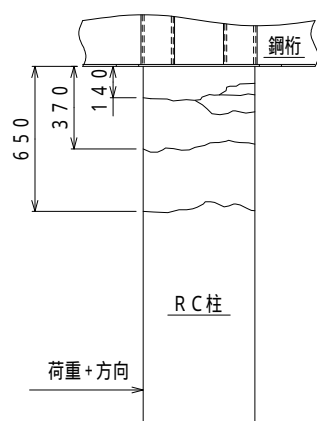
ひび割れ状況概略図 写真 - 1 補修状況
